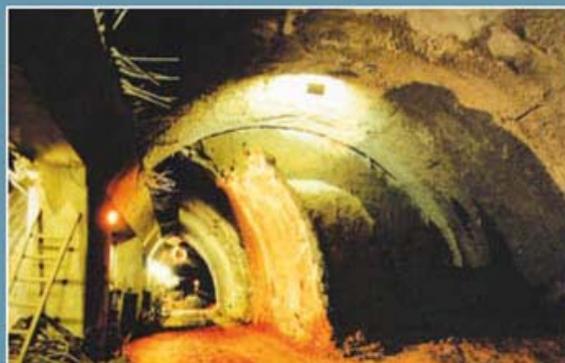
Vista do interior da estação Vila Madalena durante a escavação (CBT, 2006)
